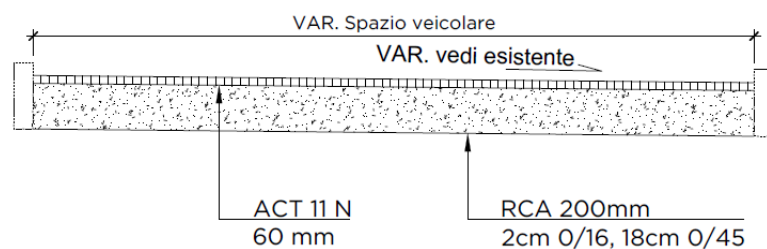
Stratigrafia pavimentazione strada privata da piano d'appalto Ruprecht SA 6926-22-02-010
